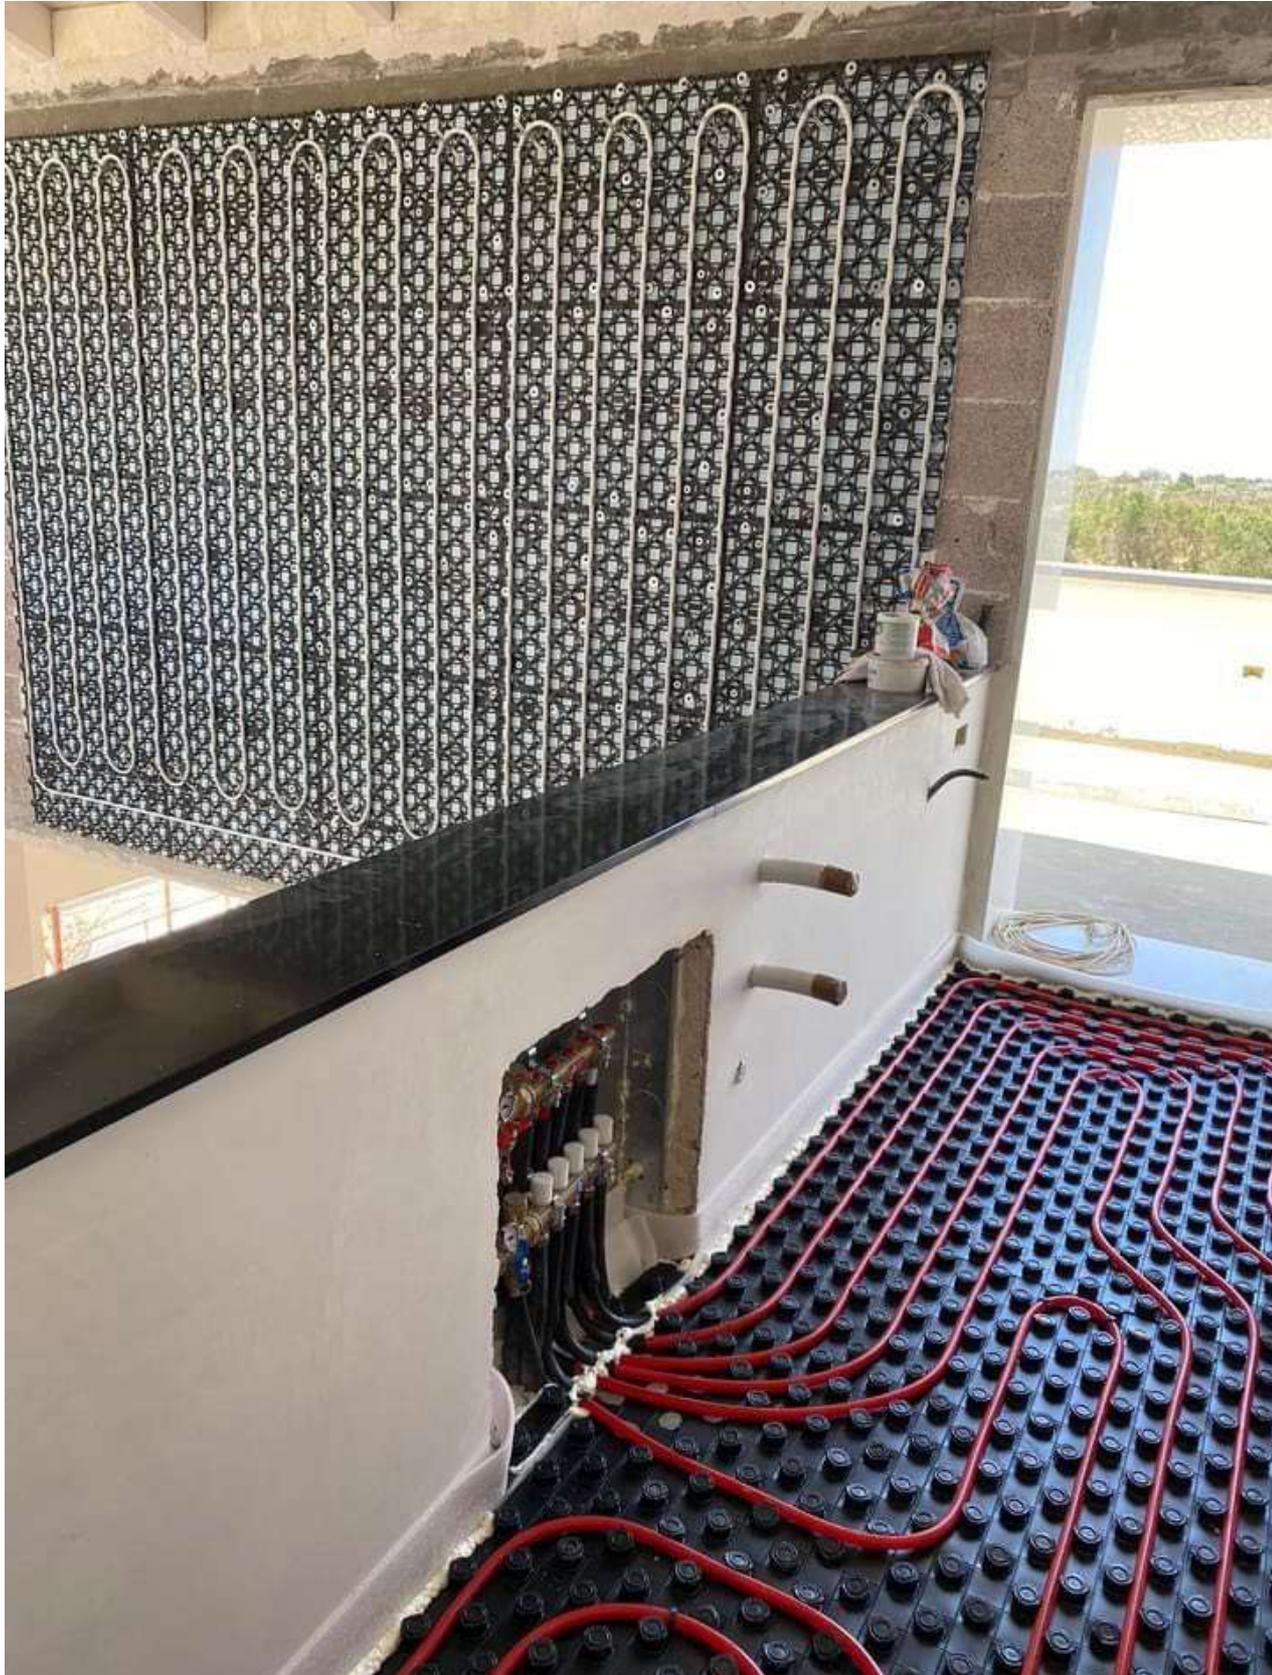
Sistema radiante a bassa inerzia termica installato a parete
